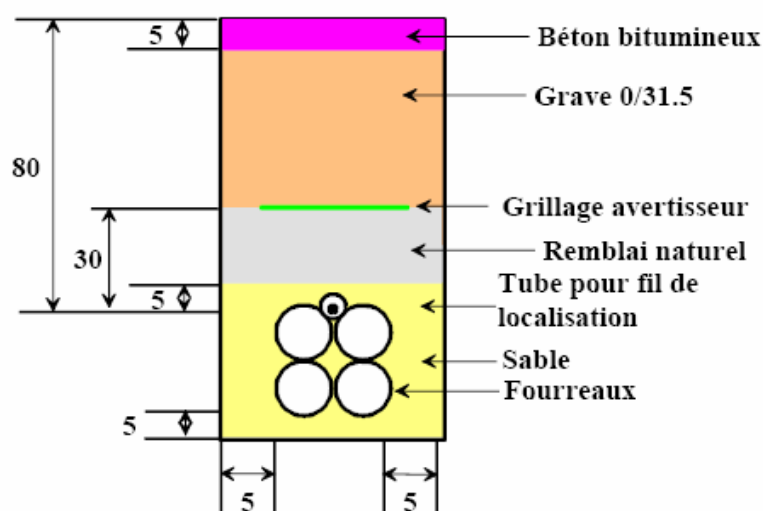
confection de tranchée et mise en place des fourreaux sous chaussée
